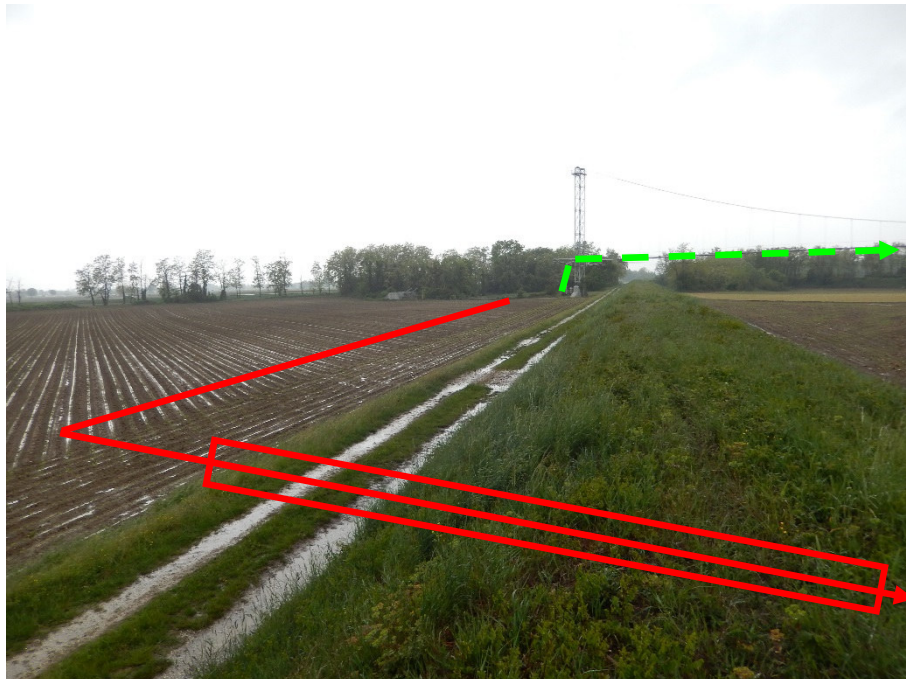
ATTRAVERSAMENTO MET. DA DISMETTERE E VARIANTE IN PROGETTO
